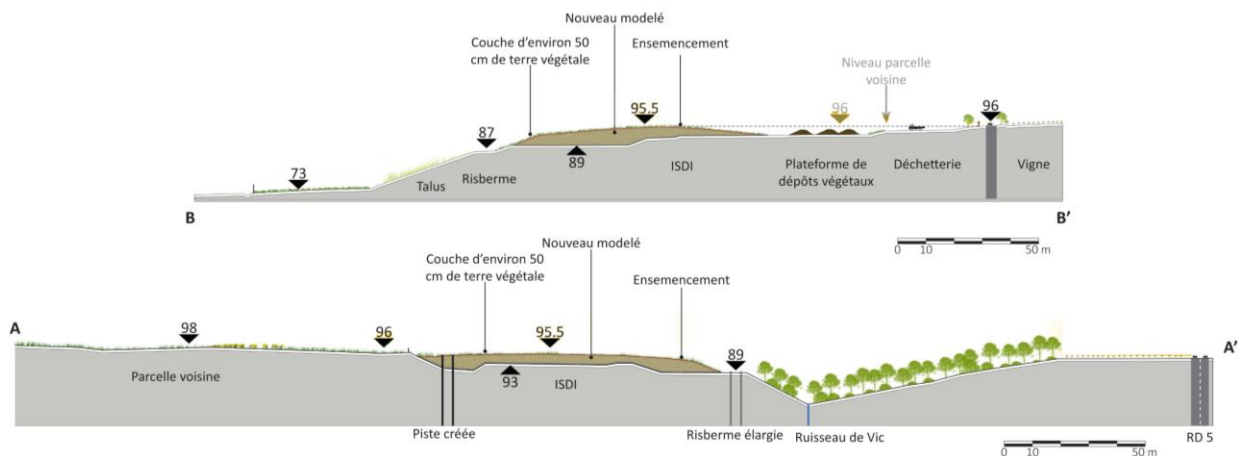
Coupes topographiques finales du site (Etude paysagère T. ALEGRE)
